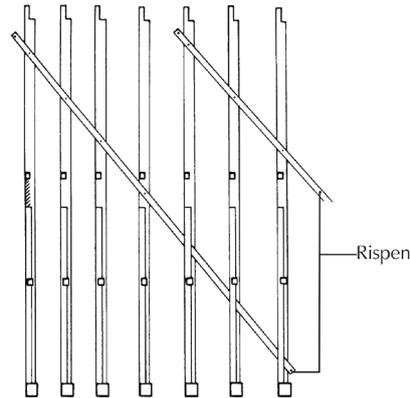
Rispens, Blick auf die Sparrenunterseiten. Biberrach an der Riß (Lkr. Biberach), Stadtpfarrkirche St. Martin, Chordach, 1337 (d).
